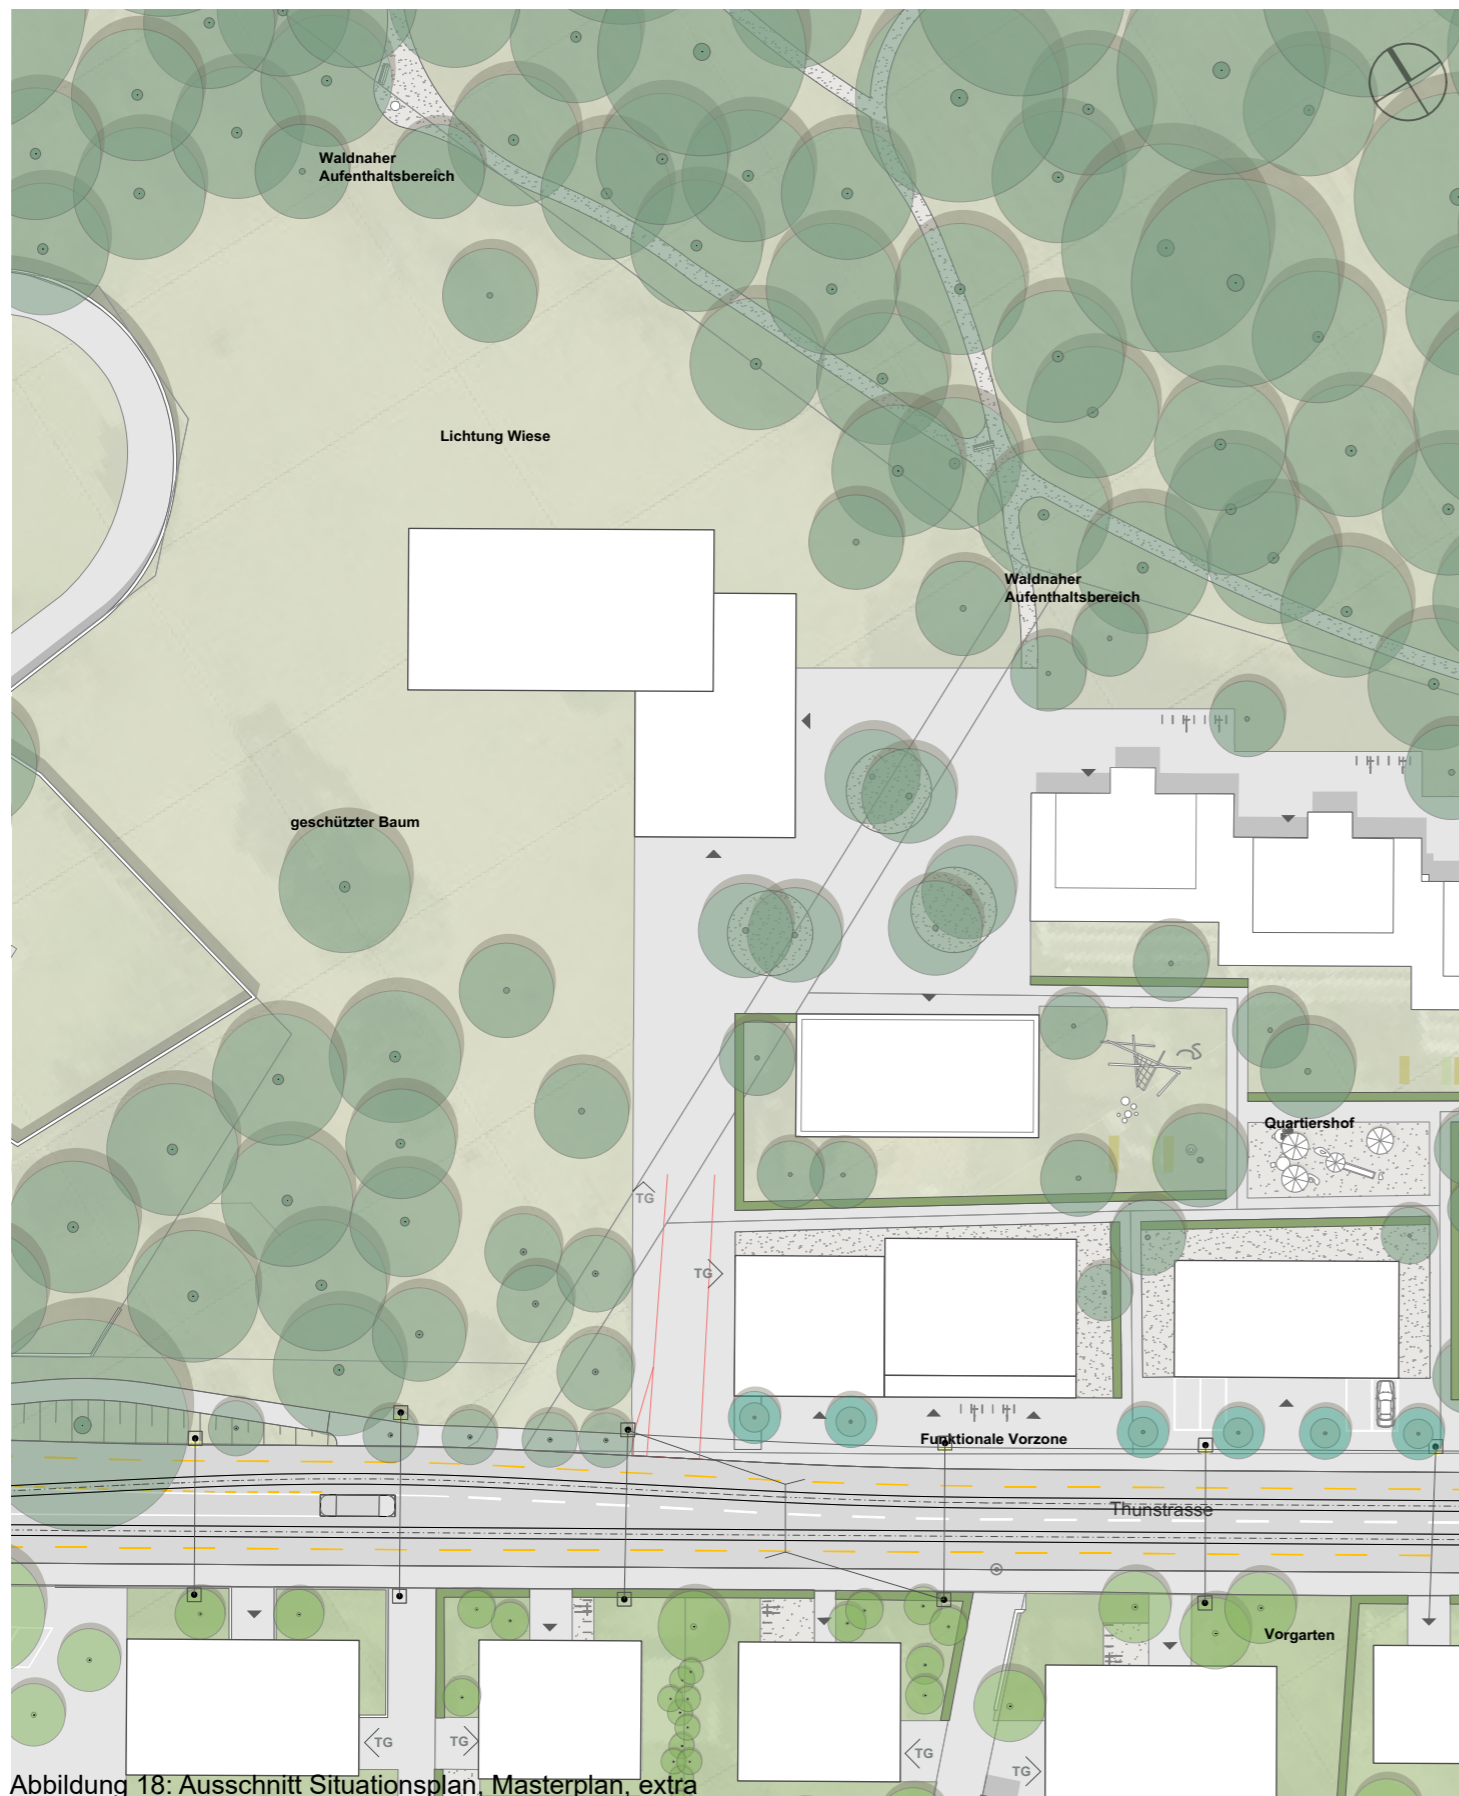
Ausschnitt Situationsplan, Masterplan, extra
